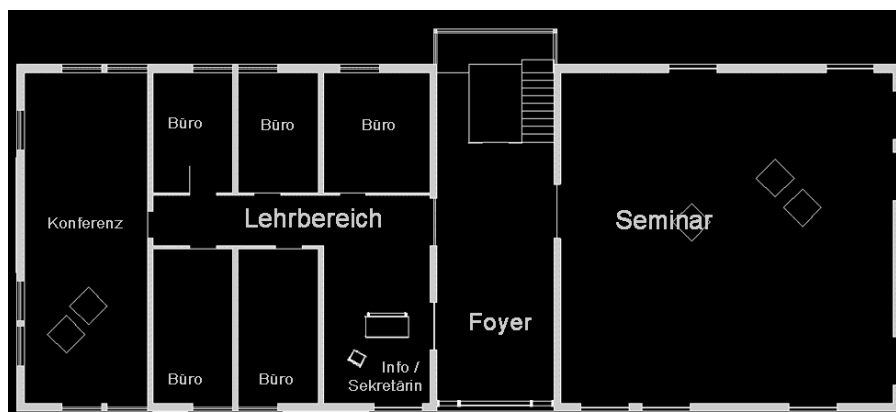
Institute – Grundriss des Lehrstuhl-Gebäudes
